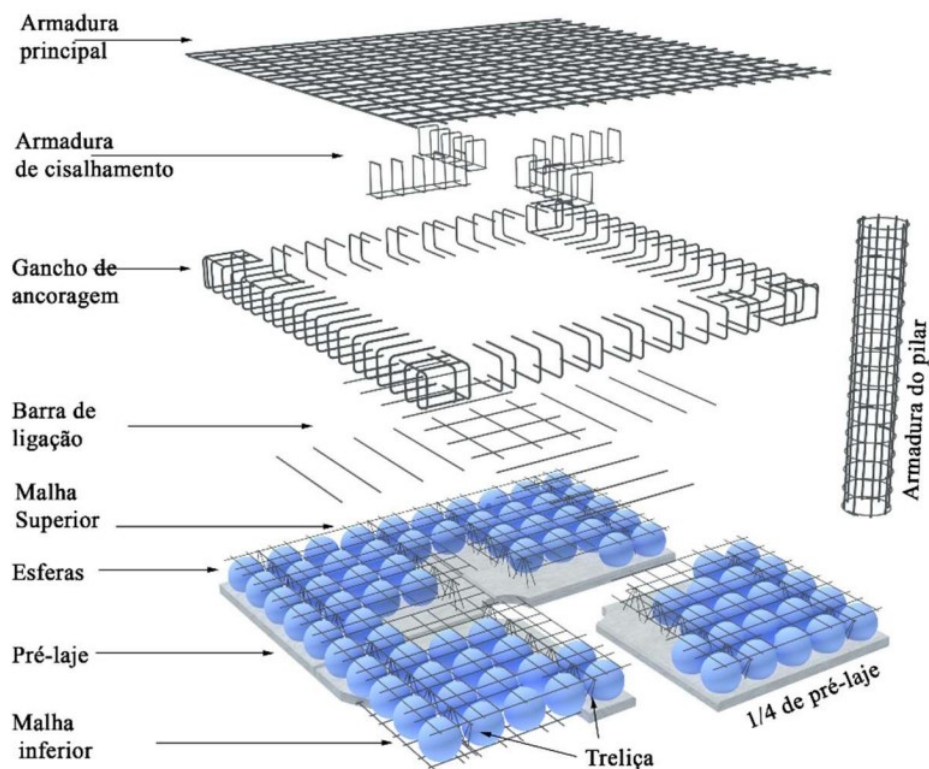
Armaduras das lajes experimentais (fonte: Nicácio (2018))
